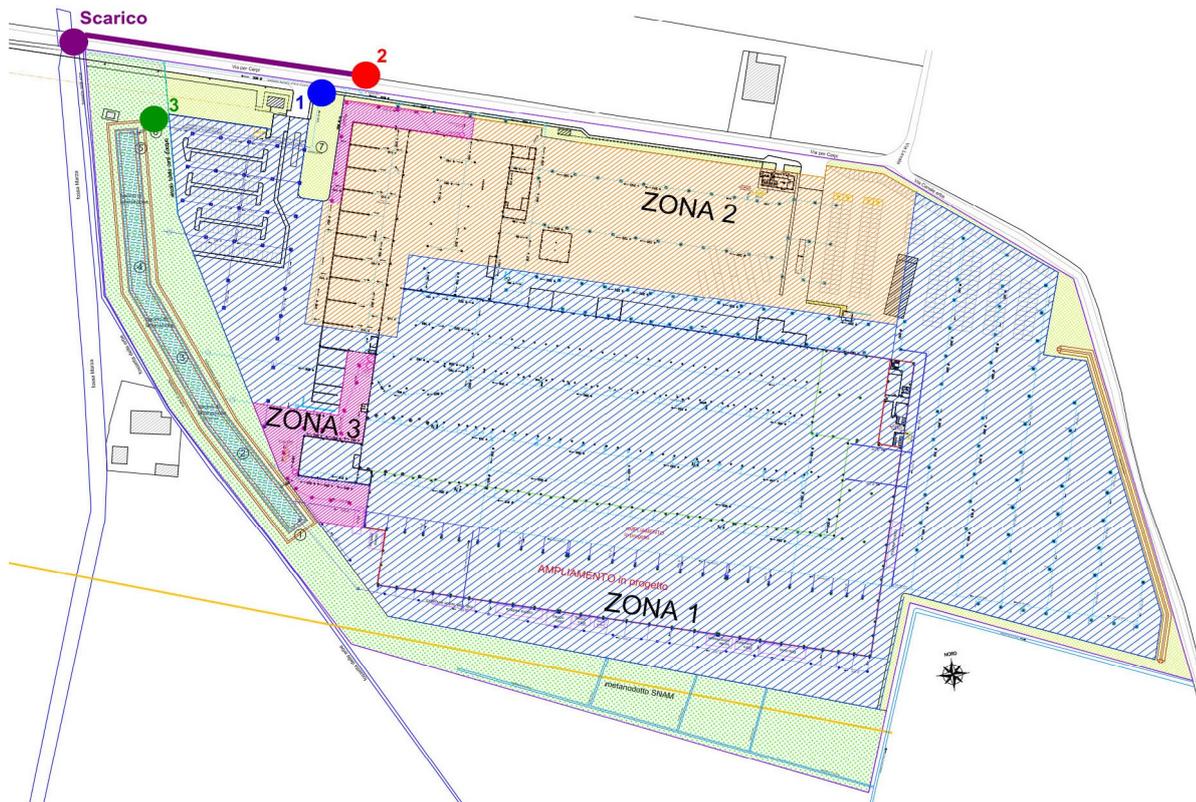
Layout PROGETTO del reticolo fognario dello stabilimento:
